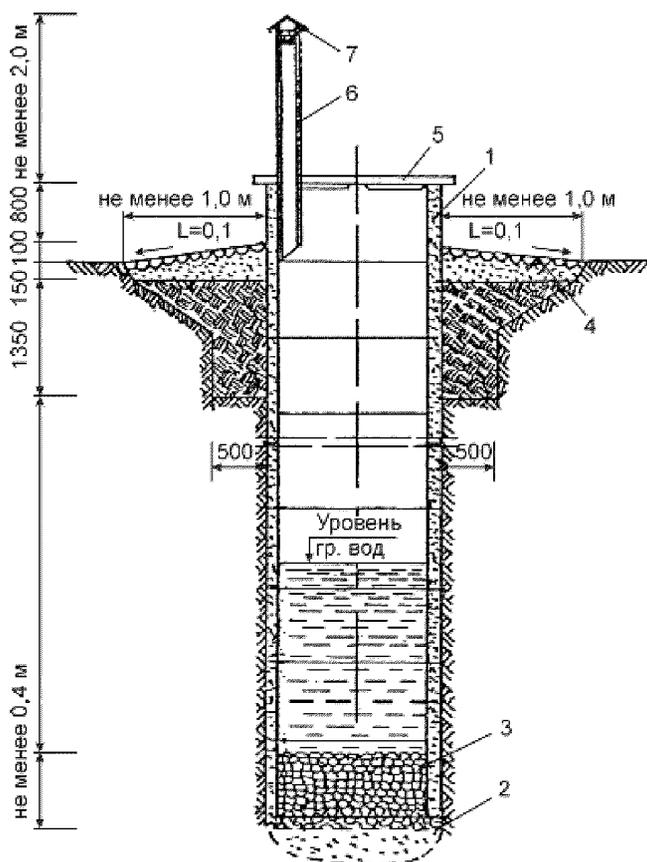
Устройство шахтного колодца из железобетонных колец;
